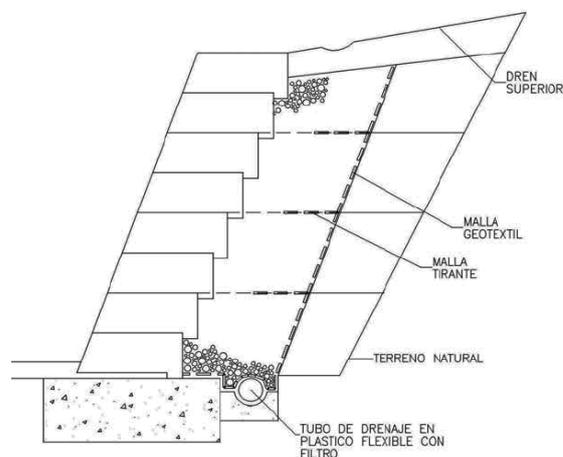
Esquema de muro de contención con sillares de hormigón atirantados.
